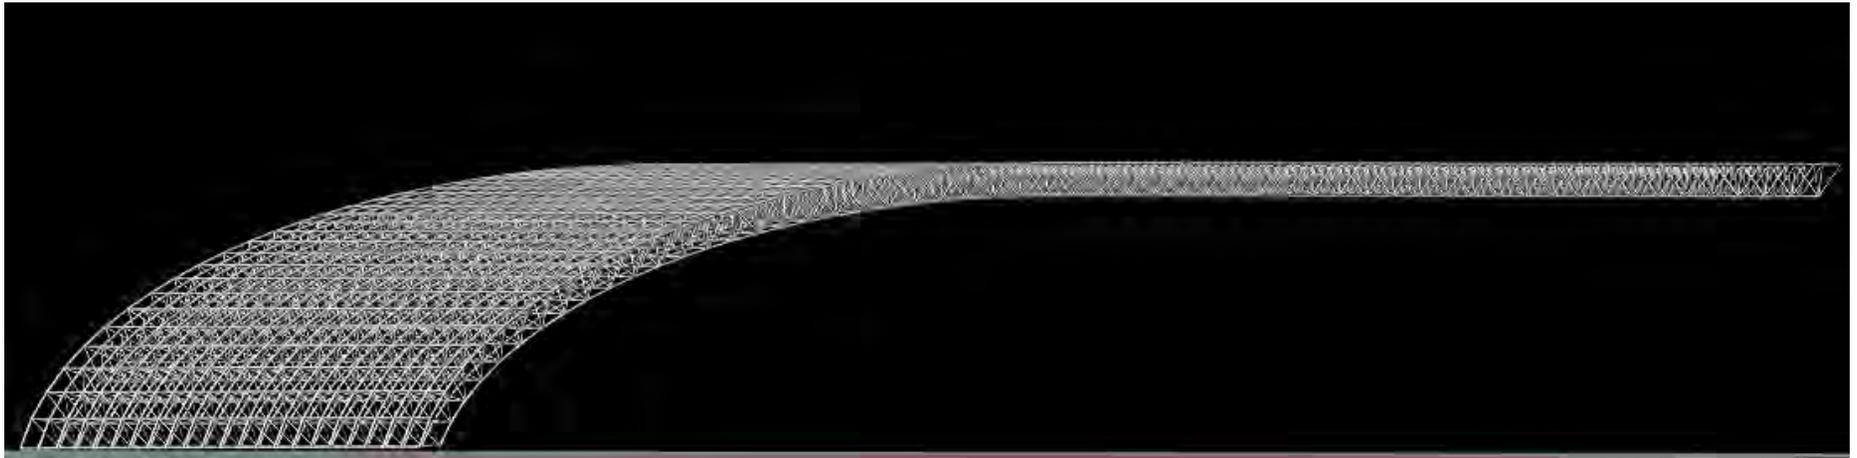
Geometría de estructura tridimensional de la nave industrial..
